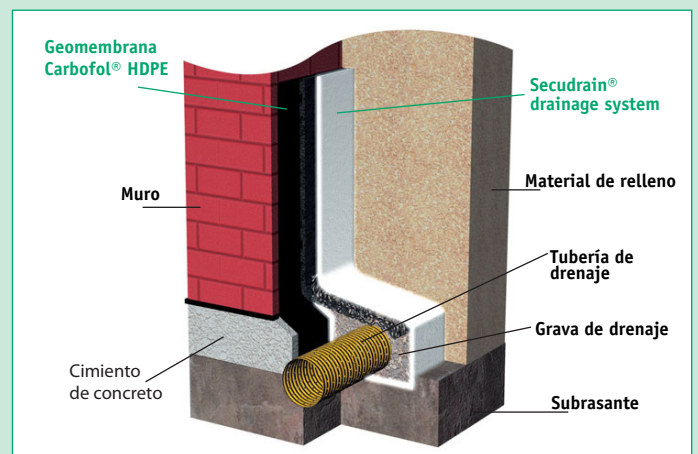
Drenaje de la estructura (detalle de la conexión de drenaje).
